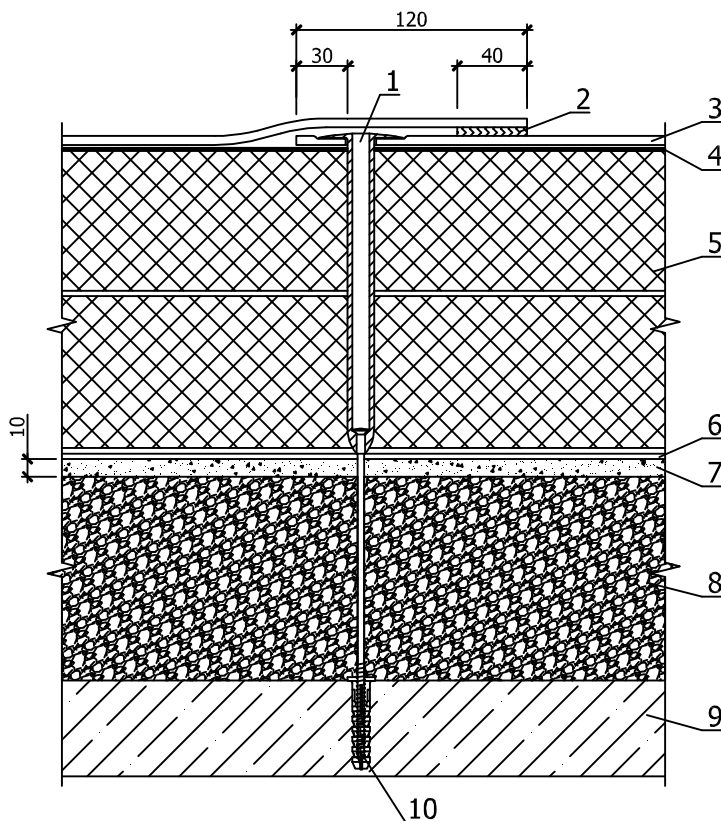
Механическое крепление мембраны к бетонному основанию покрытия:
